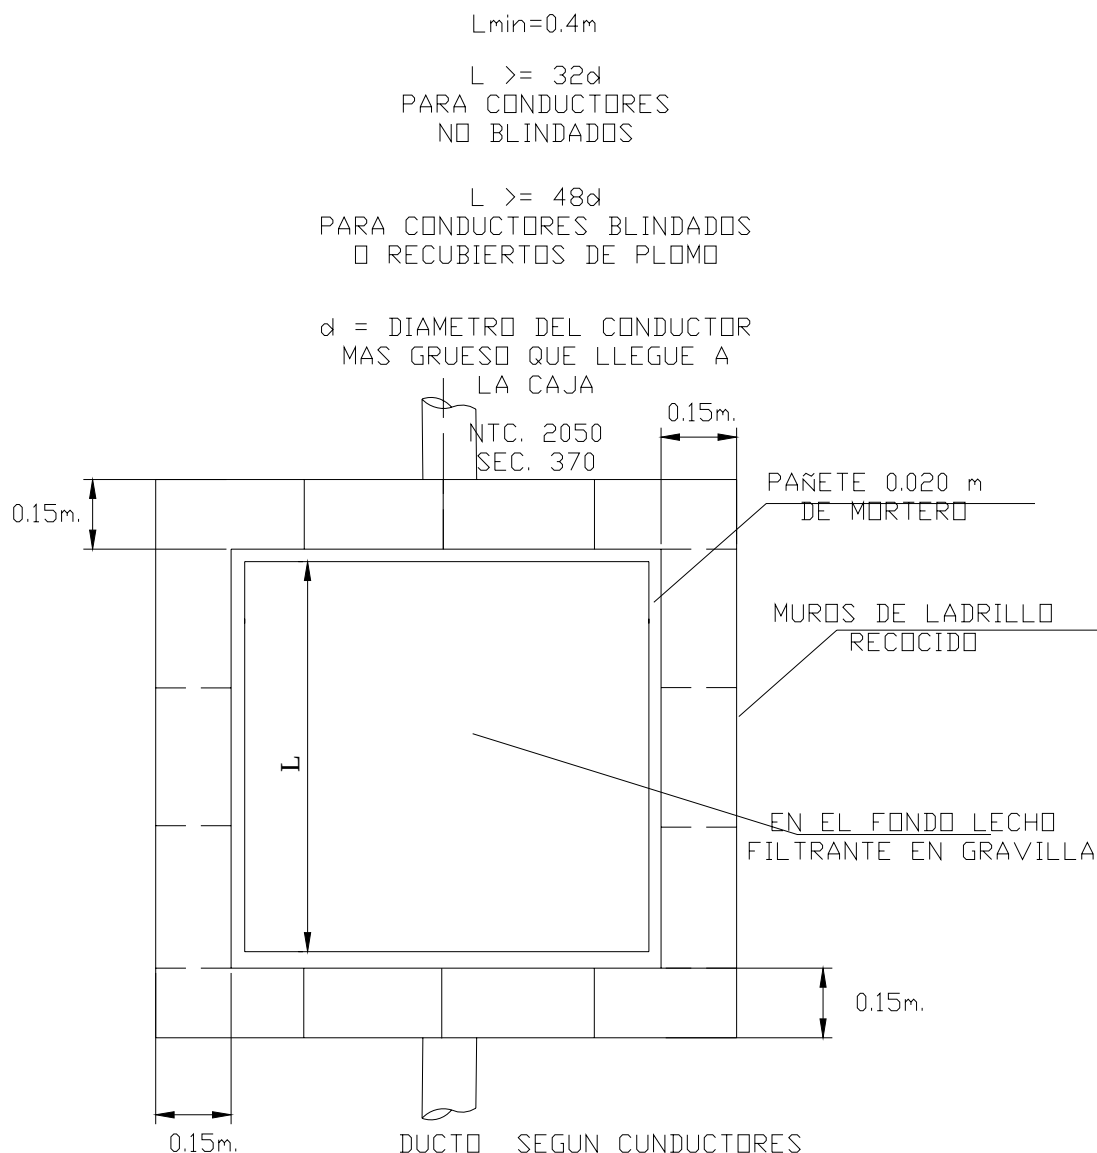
Caja de Inspección sencilla M. T vista de planta.
